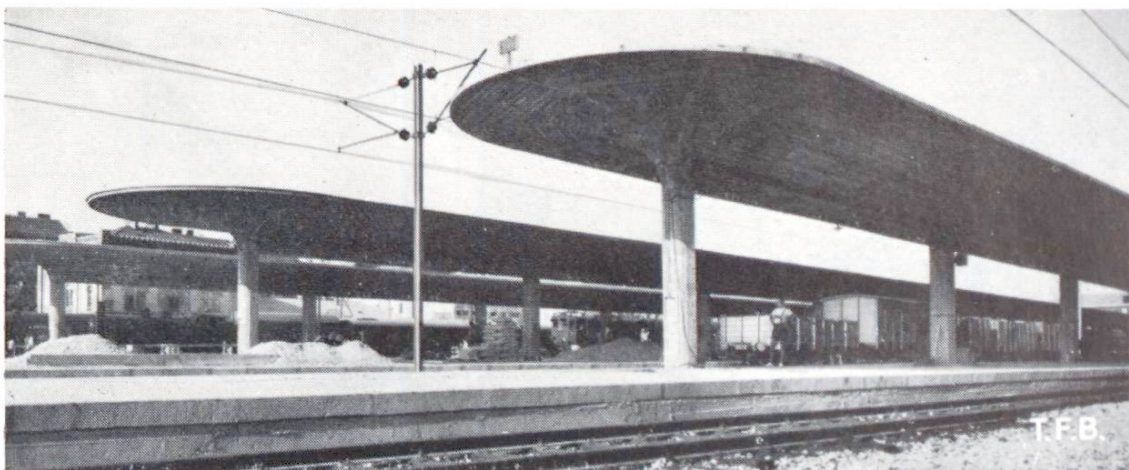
Blick auf das vordere Ende der Perronanlagen. Für die Installationen sind Aussparungen im Beton vorhanden
